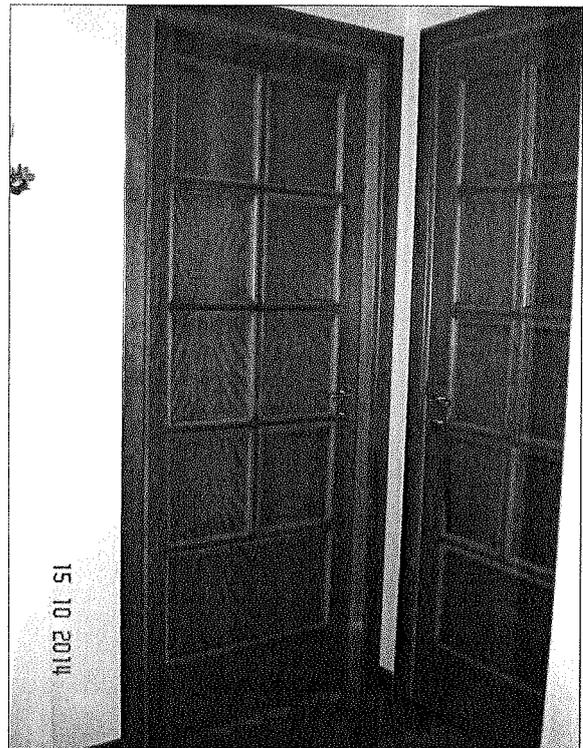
Dettaglio Porte di ingresso Camera da letto n.1 -Ripostiglio;
